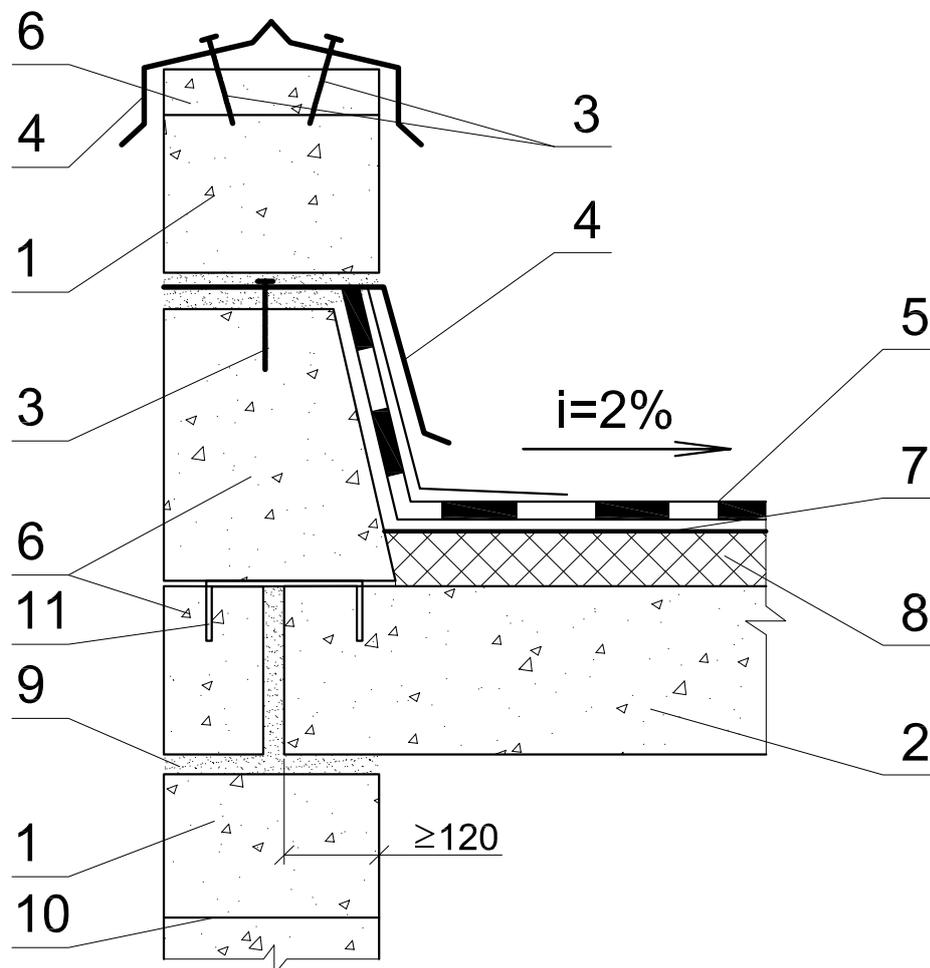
Узел опирания плиты чердачного перекрытия ГРАС на стену при устройстве чердачной крыши
